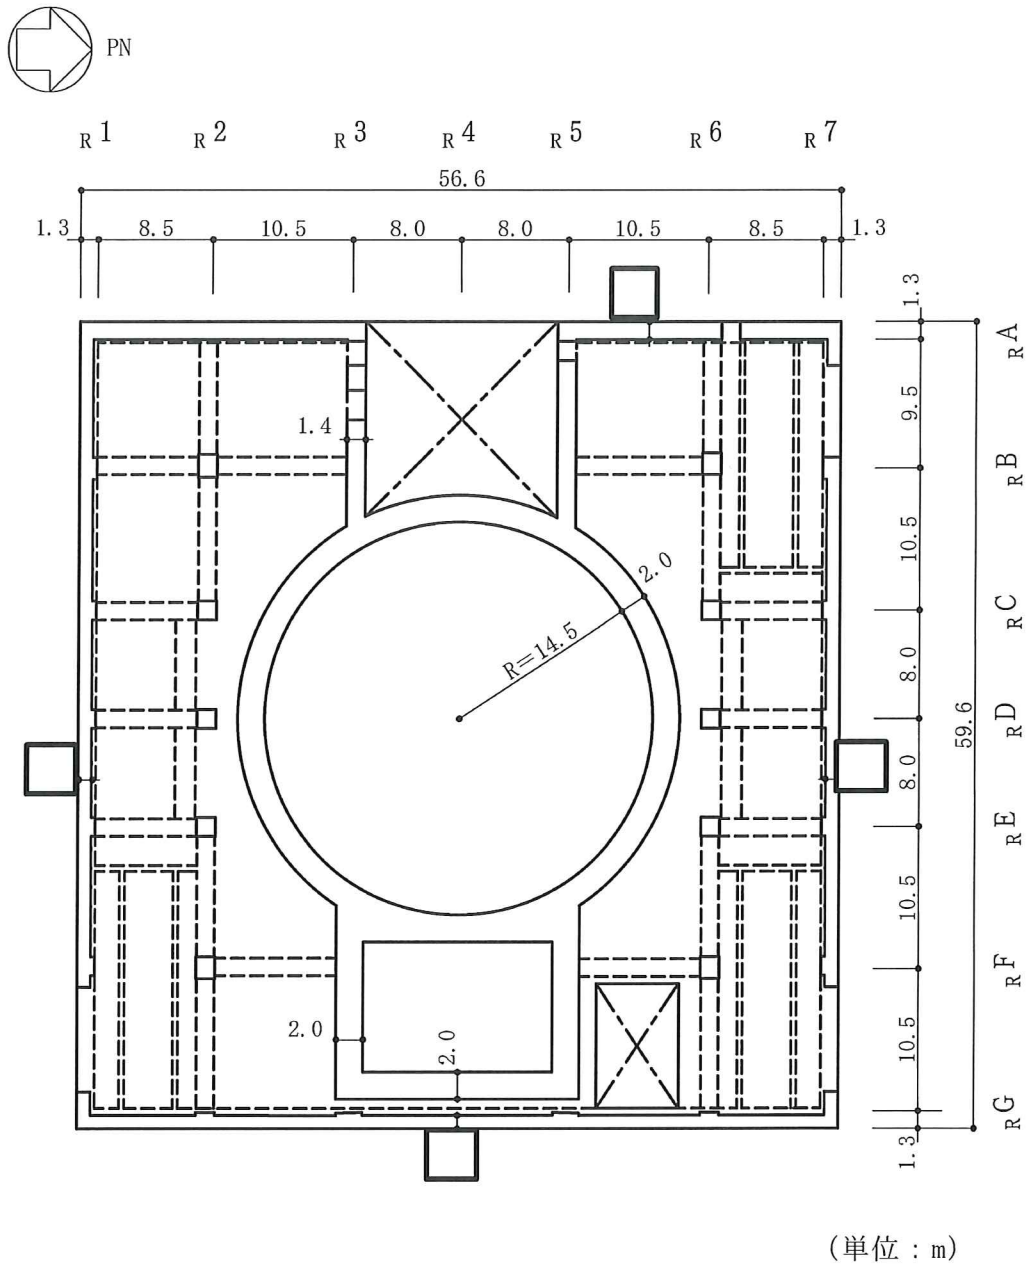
6号機原子炉建屋の概略平面図 (2F, T.M.S.L. 18.1m) (5/9)
